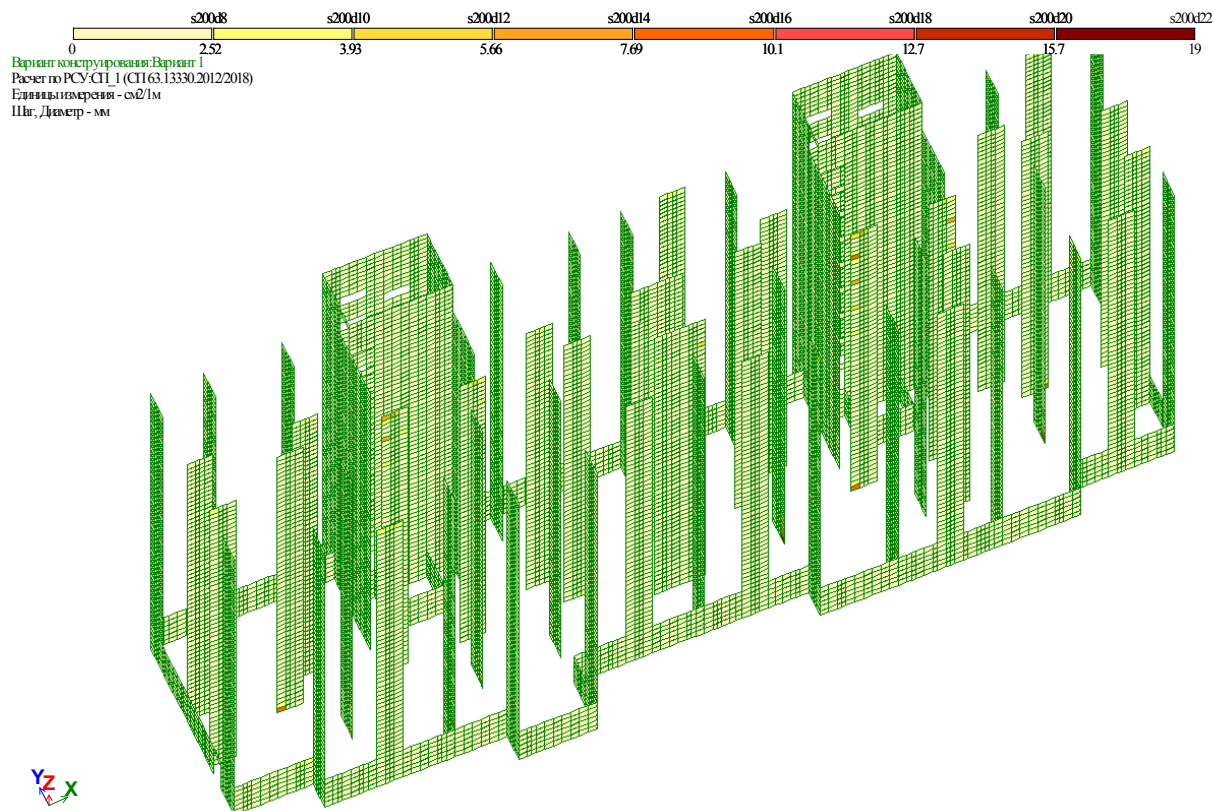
Площадь полной арматуры на 1м по оси X у нижней грани (балки-стенки - посередине)
